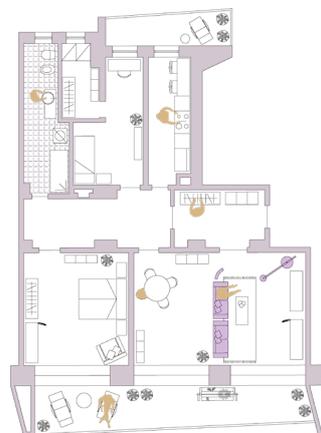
Rappresentazione planimetrica appartamento Palazzo INA con arredi.
